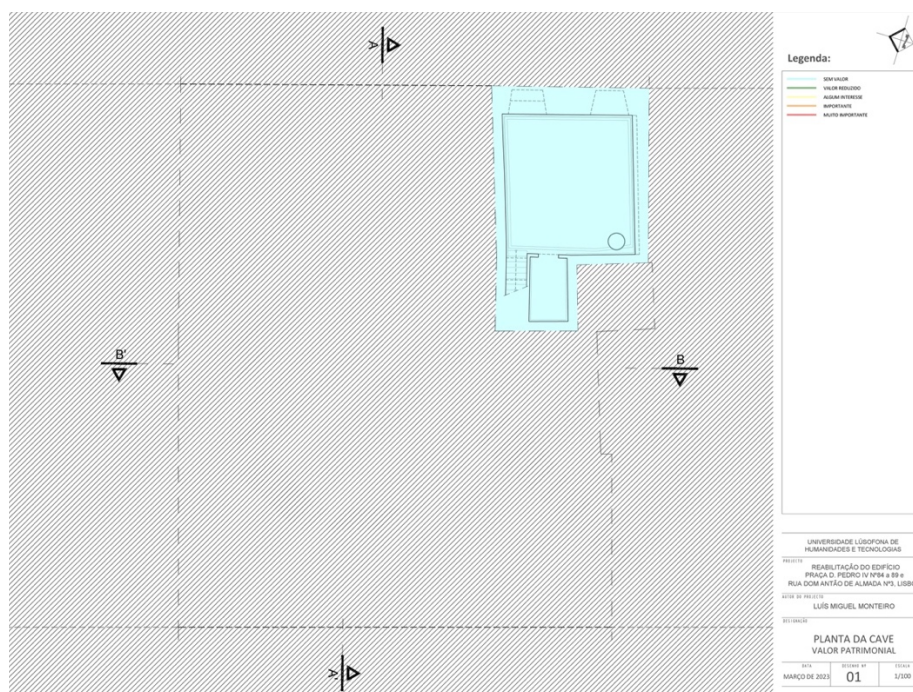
Planta da Cave, que se considera desprovida de valor cultural.
